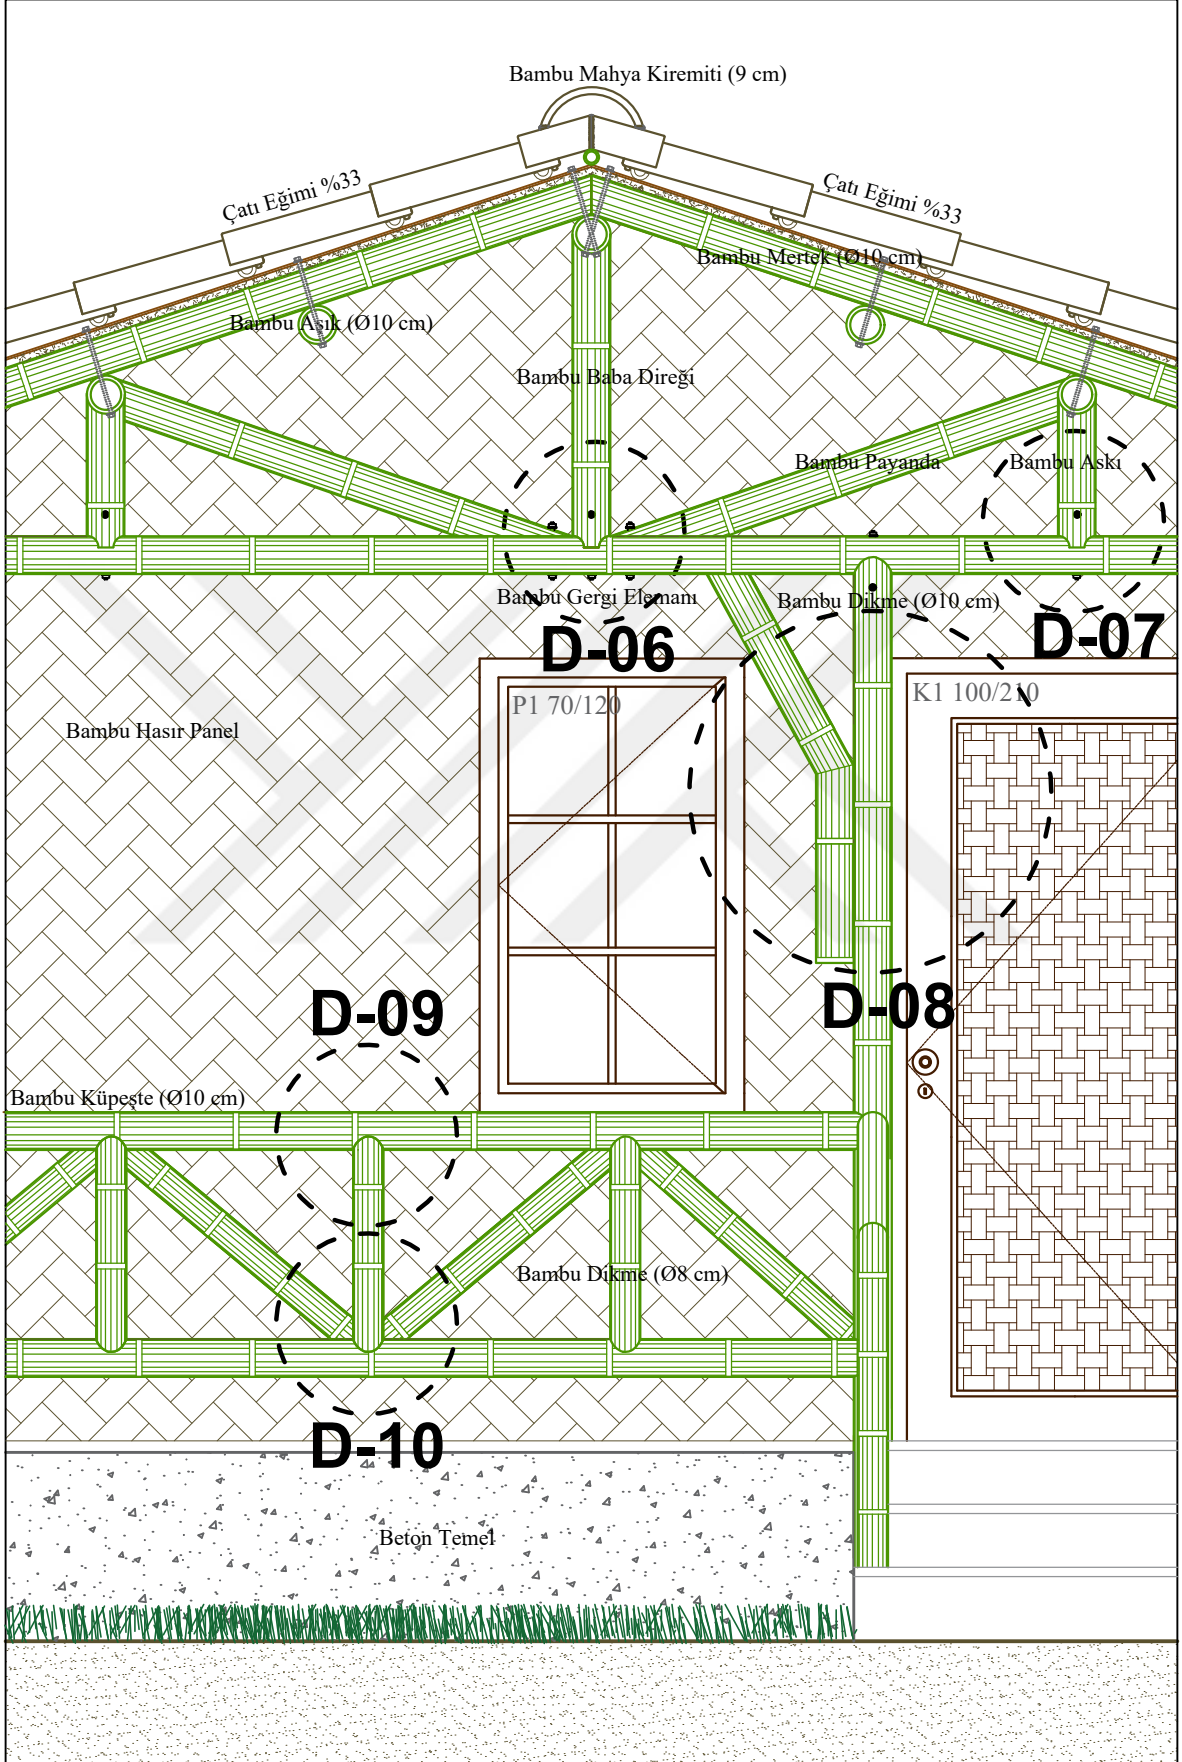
Bambu modelin sistem planı ölçek:1/20
